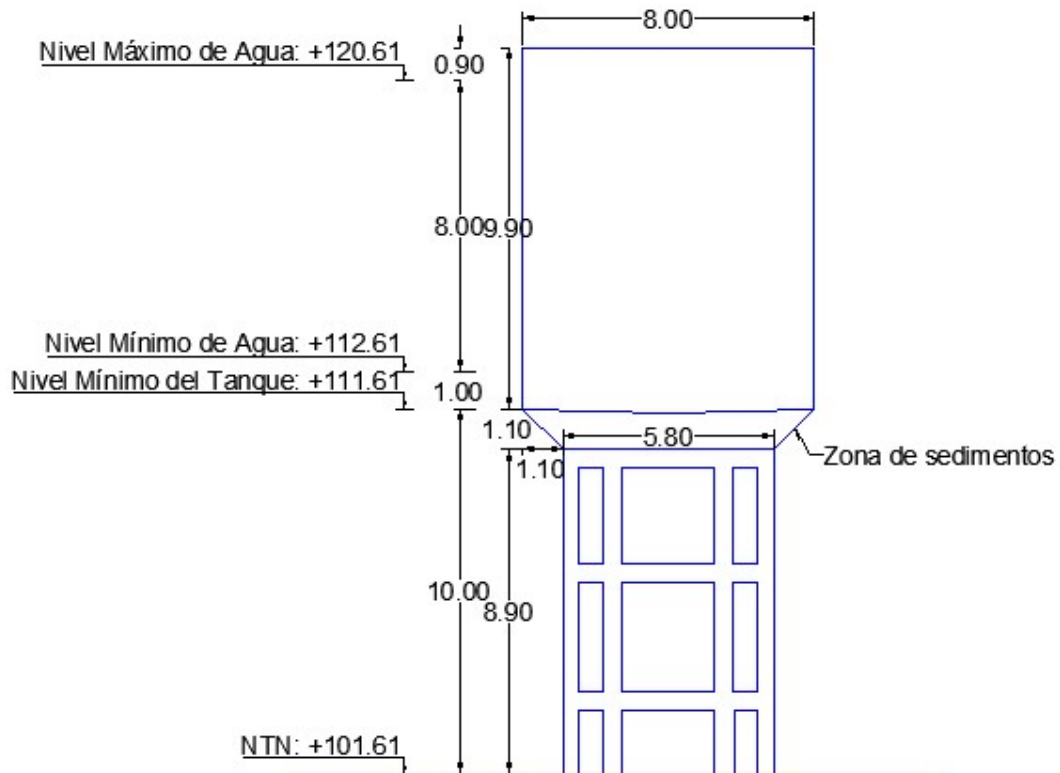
Vista en elevación del tanque elevado para riego [López & Zambrano, 2021].
